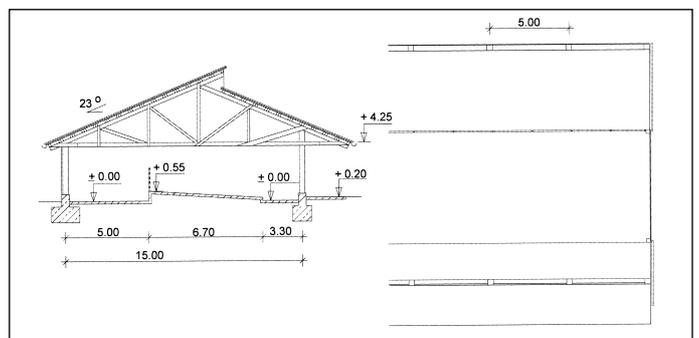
Schnitt und Grundriss für einen Mutterkuhstall mit Tretmist und Strohlager
